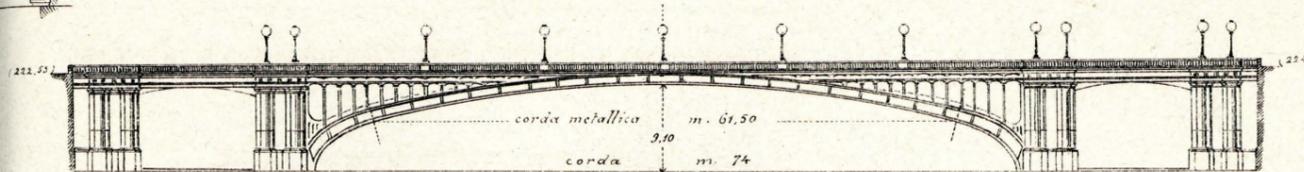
Progetto di ponte di struttura mista dell'Ing. Ghiotti.
